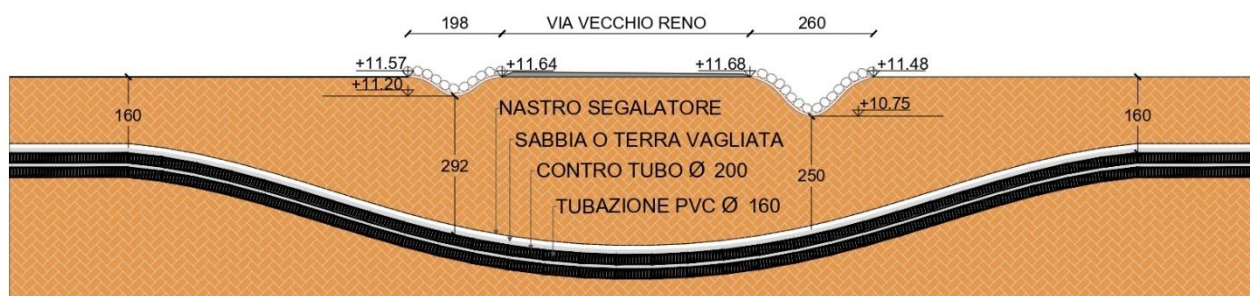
Tratto F-F' - Sezione attraversamento Via Vecchio Reno
